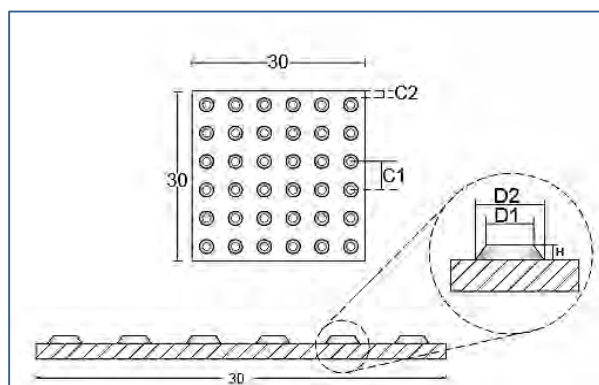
Pavimento de Advertencia. Fuente: SEDUVI, 2012.
